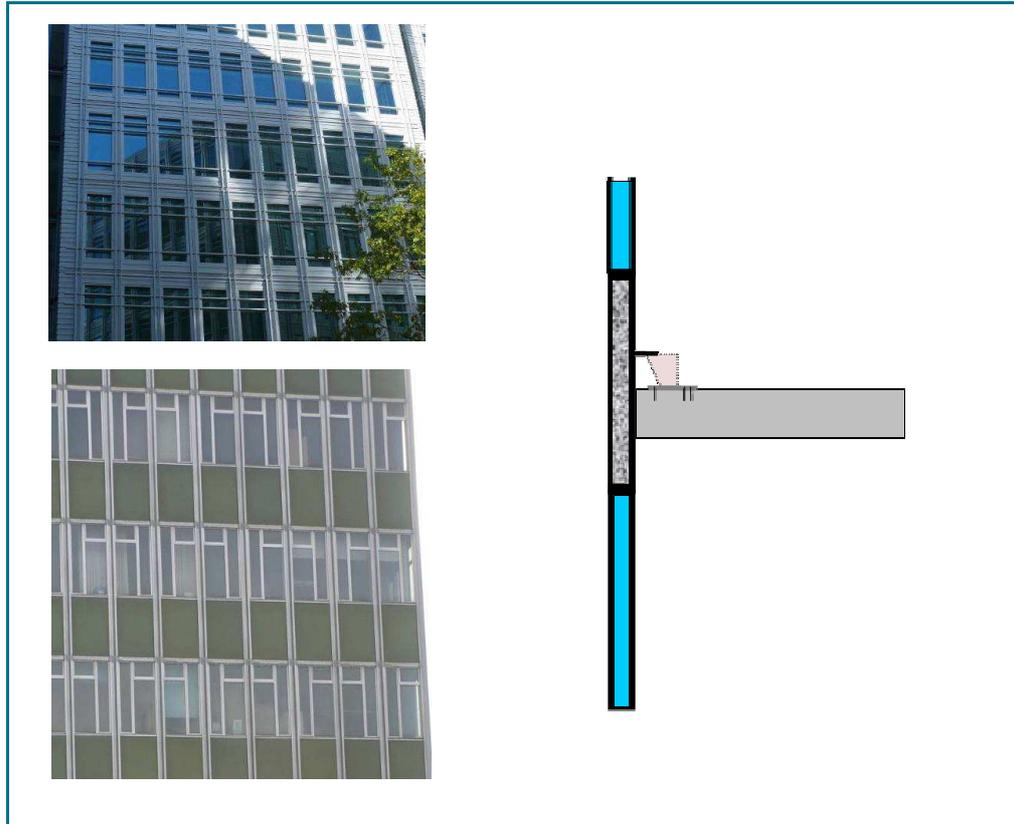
Façades rideaux avec éléments non vitrés, en bas à droite une coupe verticale de principe
